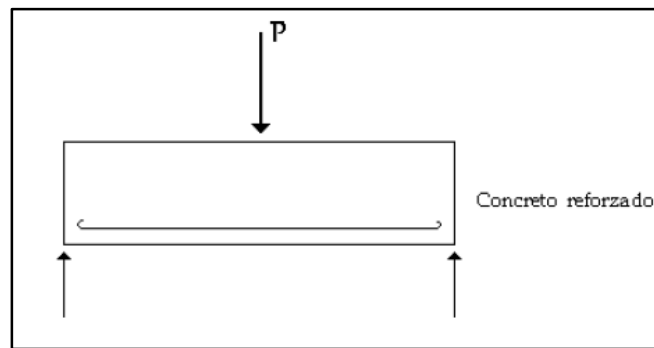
Imagen de una viga de concreto reforzado sometida a una carga P.
